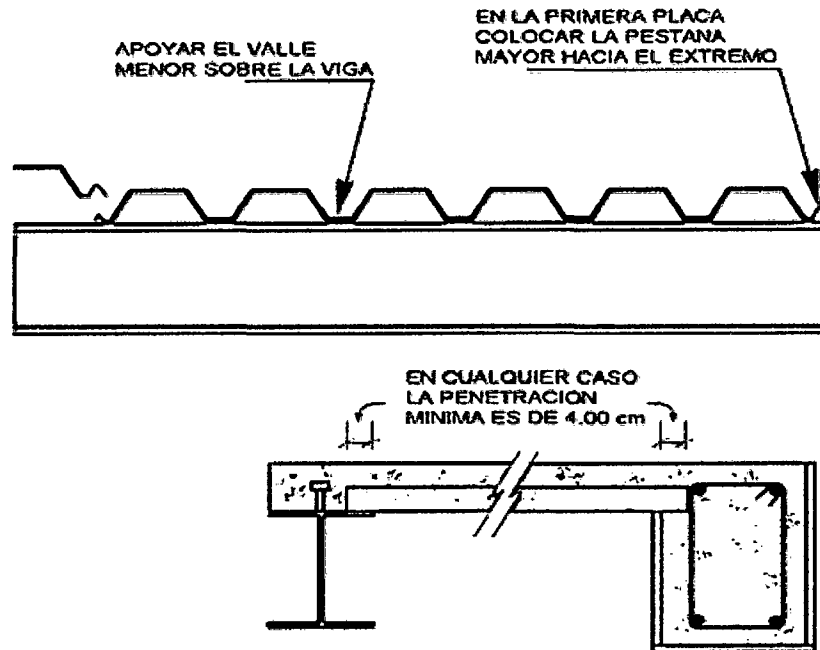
Colocación o unión de la placa Colaborante con la viga
